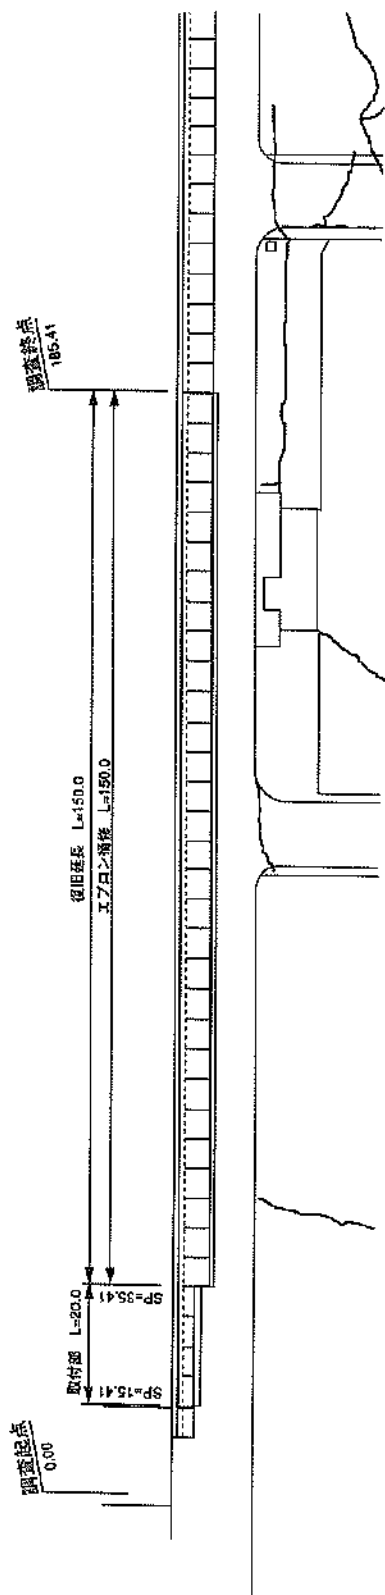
厚岸漁港 (湖南地区) ⑧—3.0m岸壁被災状況平面図
